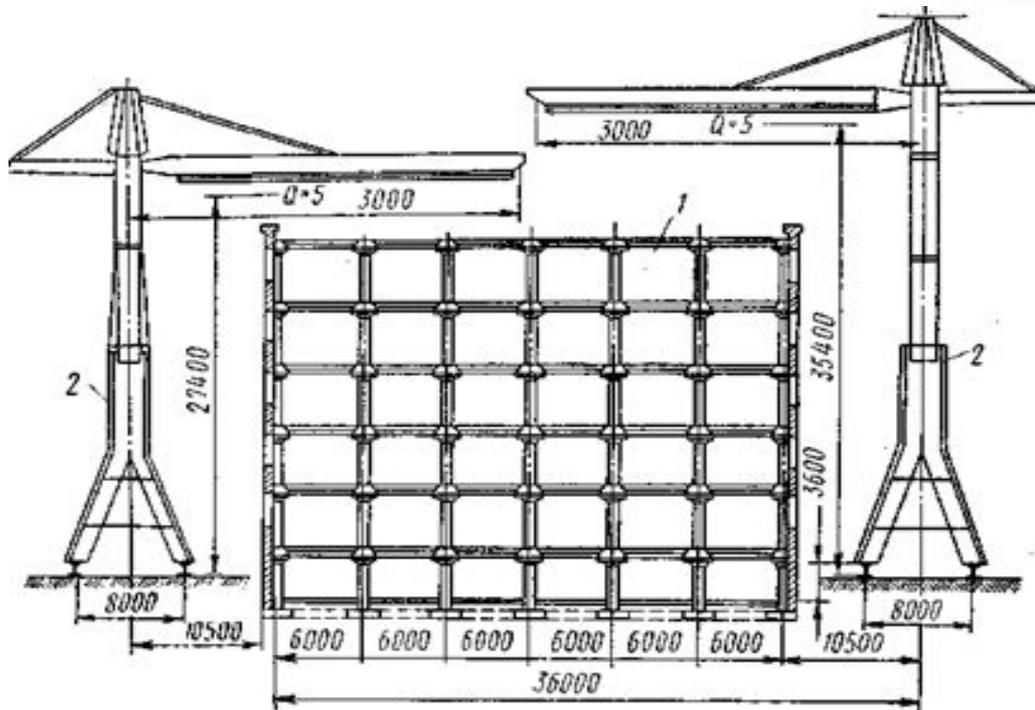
Схема монтажа многоэтажного промышленного здания: 1 — каркас; 2 — башенные краны БК.СМ-14
